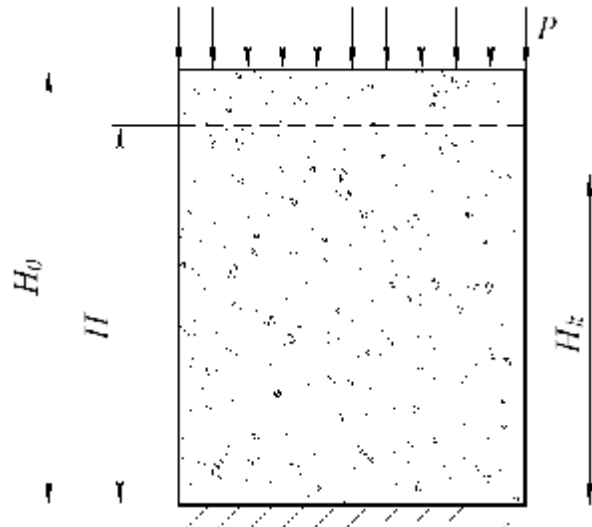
Расчетная схема пластического деформирования цементобетонного слоя
